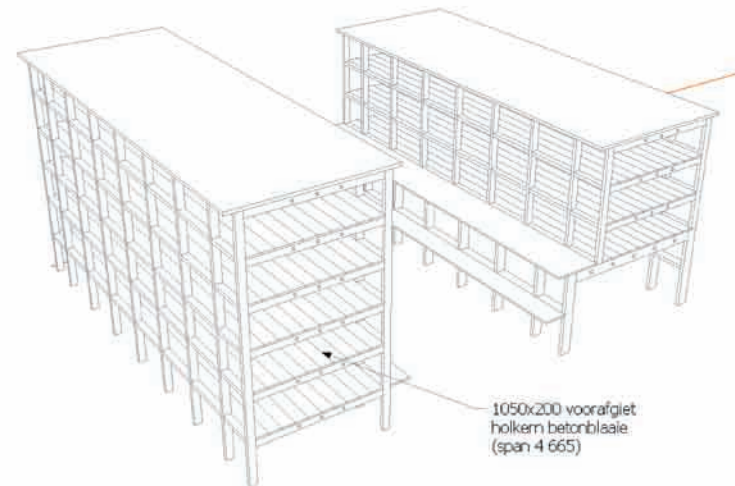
Voorgiet holkern betonblaaië op in-situ balke
